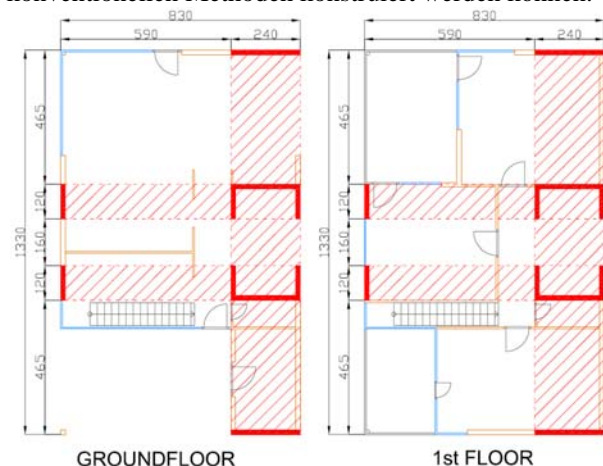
Grundrisse: Die roten Wände stellen die aussteifenden Wände dar. Die strichlierten roten Deckenelemente stellen die steifen Deckenelemente (Hauptstruktur) dar.
